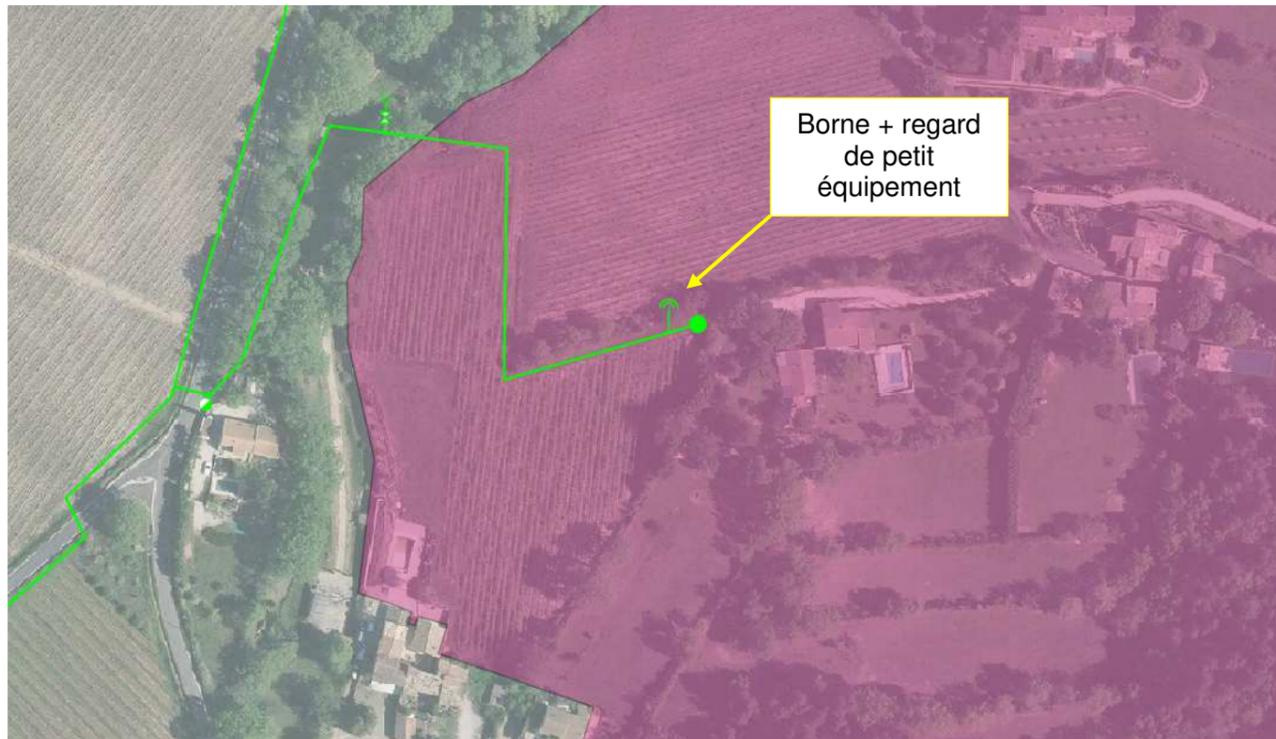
Zoom Secteur est (Les Goujons) sur fond photo aérienne (source : Orthophoto) – En vert : projet / en noir : réseau et ouvrages existants
